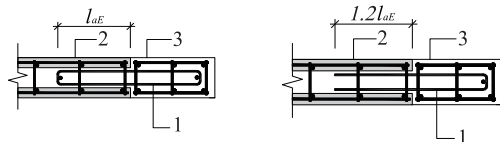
混凝土现浇段一侧有叠合剪力墙连接节点
